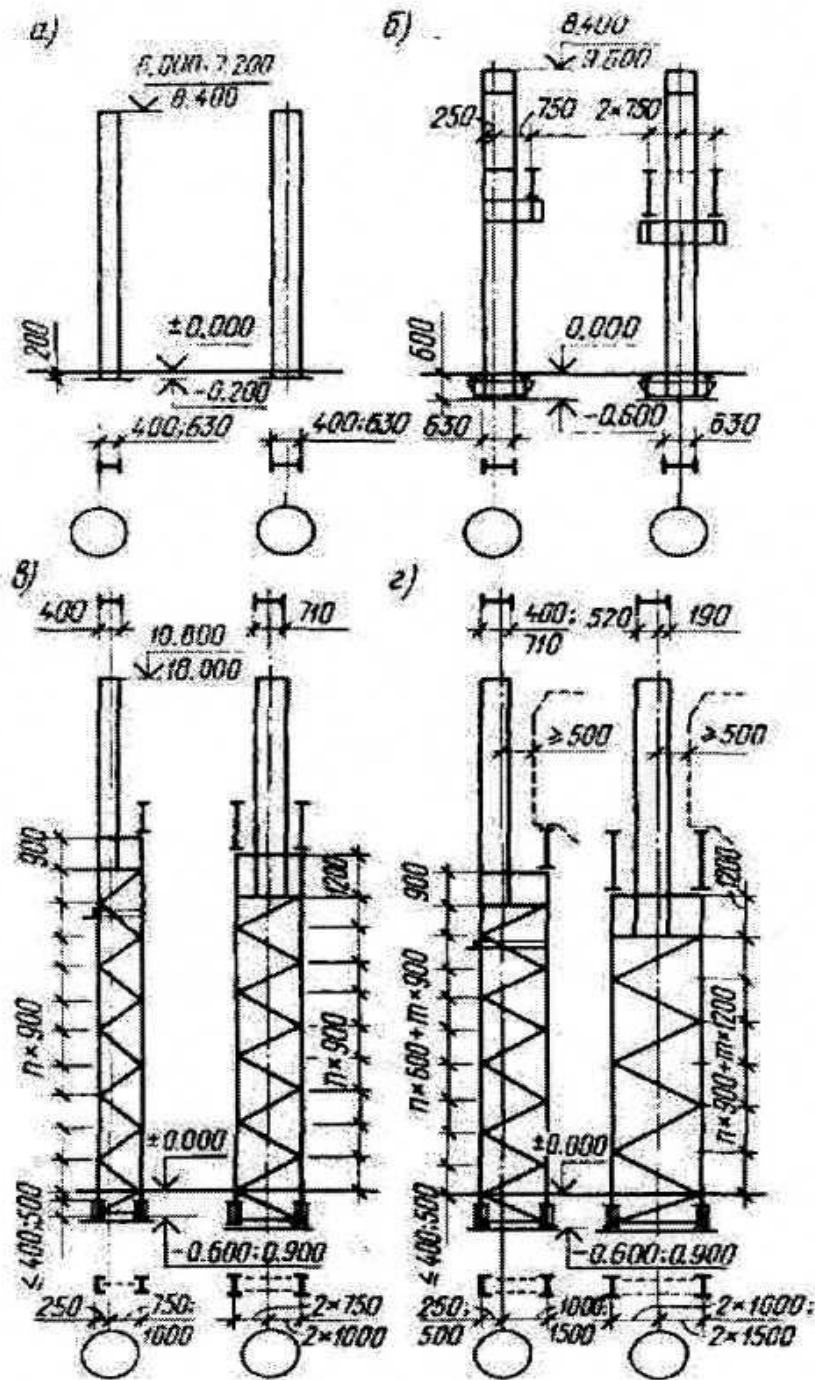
Стальные колонны одноэтажных промышленных зданий: а - одноветвевые без опорных кранов; б - одноветвевые с опорными кранами до 20 т; в - двухветвевые с опорными кранами до 50 т; г - двухветвевые с опорными кранами и проходом
